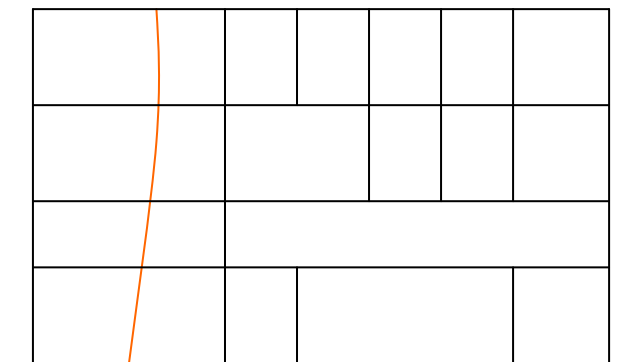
COLUMNA NO VERTICAL Y COLUMNAS DISCONTINUAS
